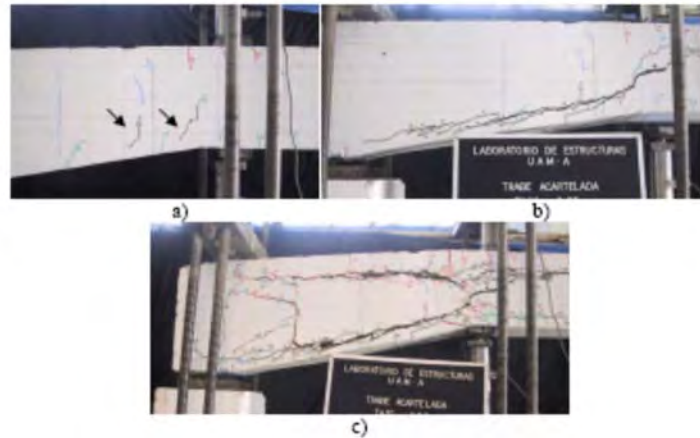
Estados característicos: a) primer agrietamiento diagonal, b) agrietamiento de falla, y c) colapso (Archundia *et al.* 2007)
